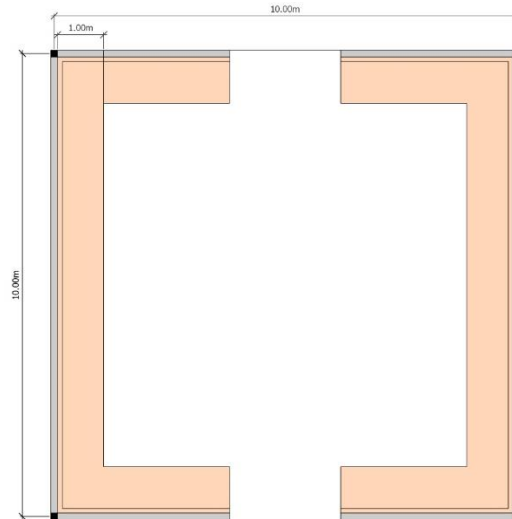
Denah Typical Ruang Kebudayaan Wayang dan Batik Solo
